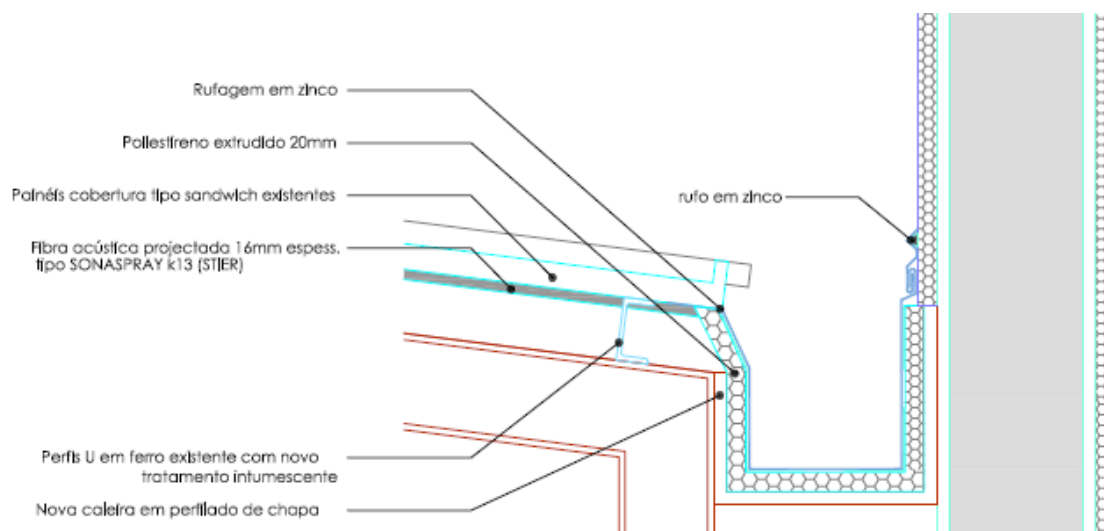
Pormenor de Cobertura com Painéis Sandwich
